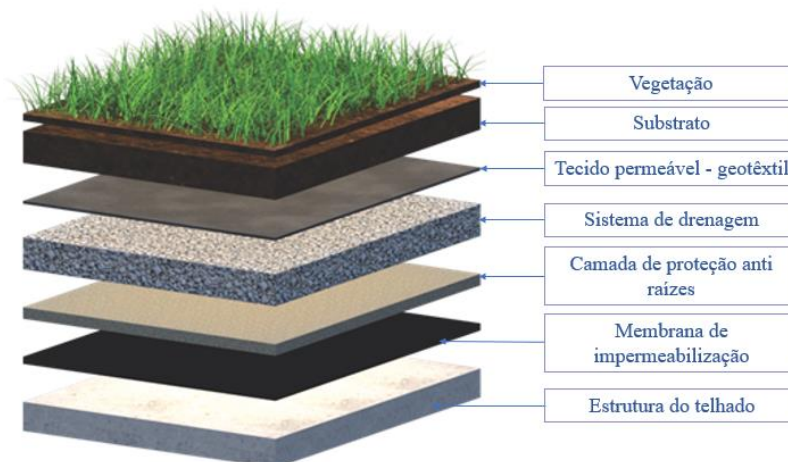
Pormenor construtivo do sistema de coberturas verdes
